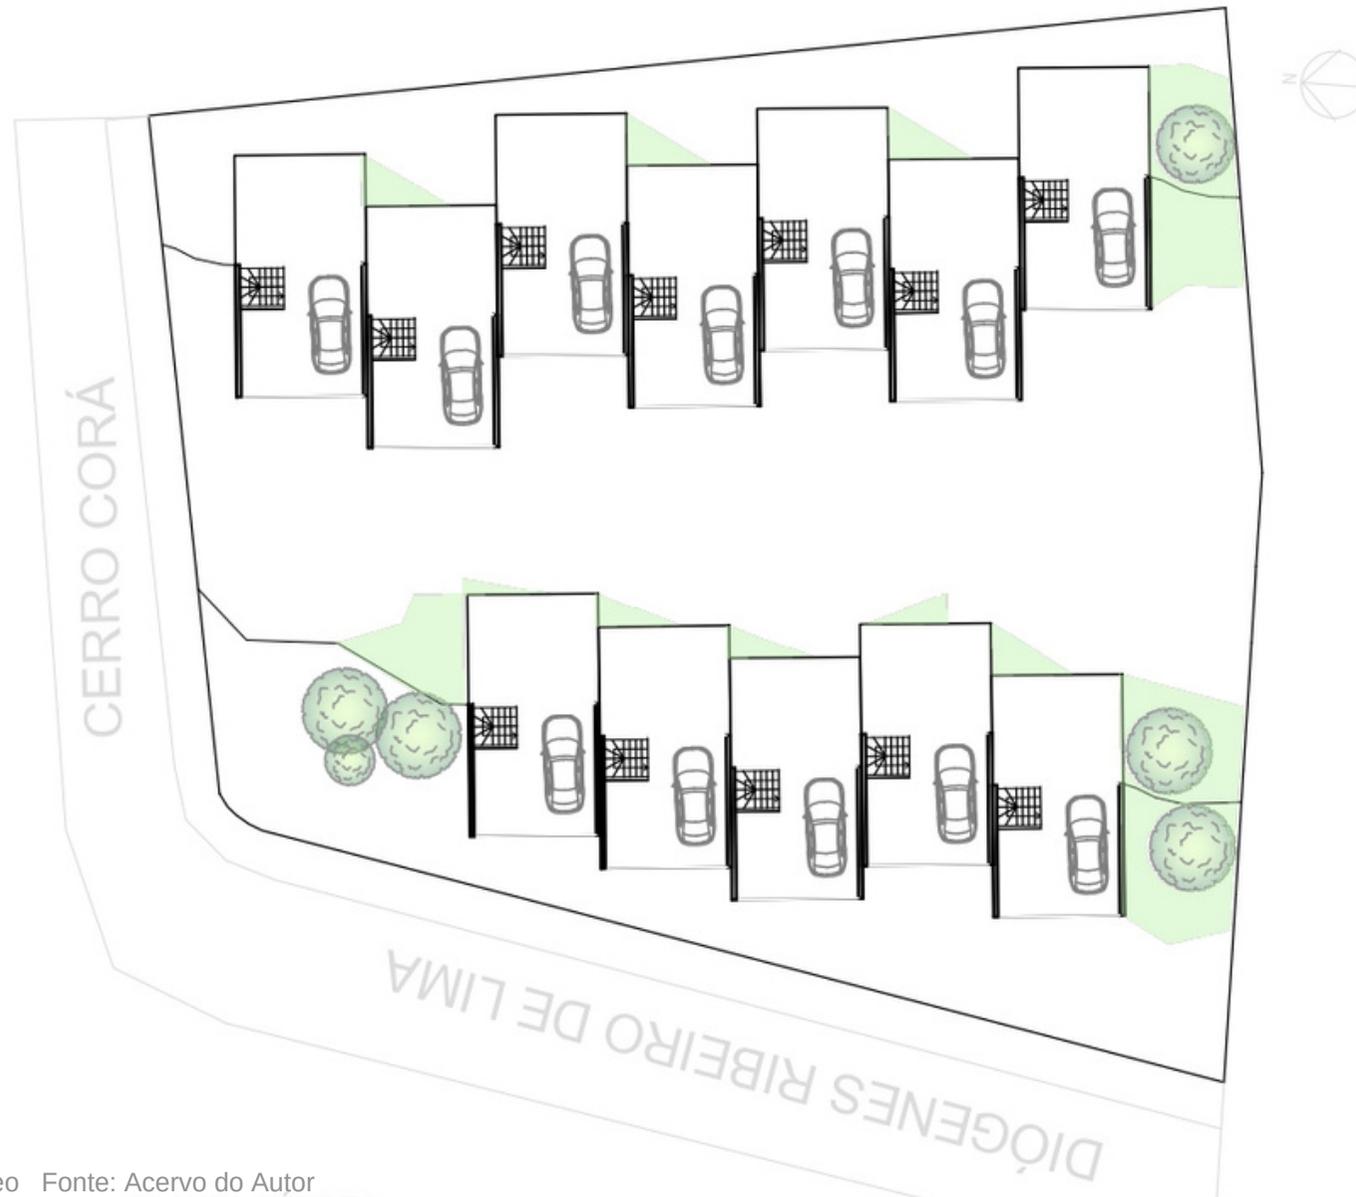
Planta Térreo Fonte: Acervo do Autor
